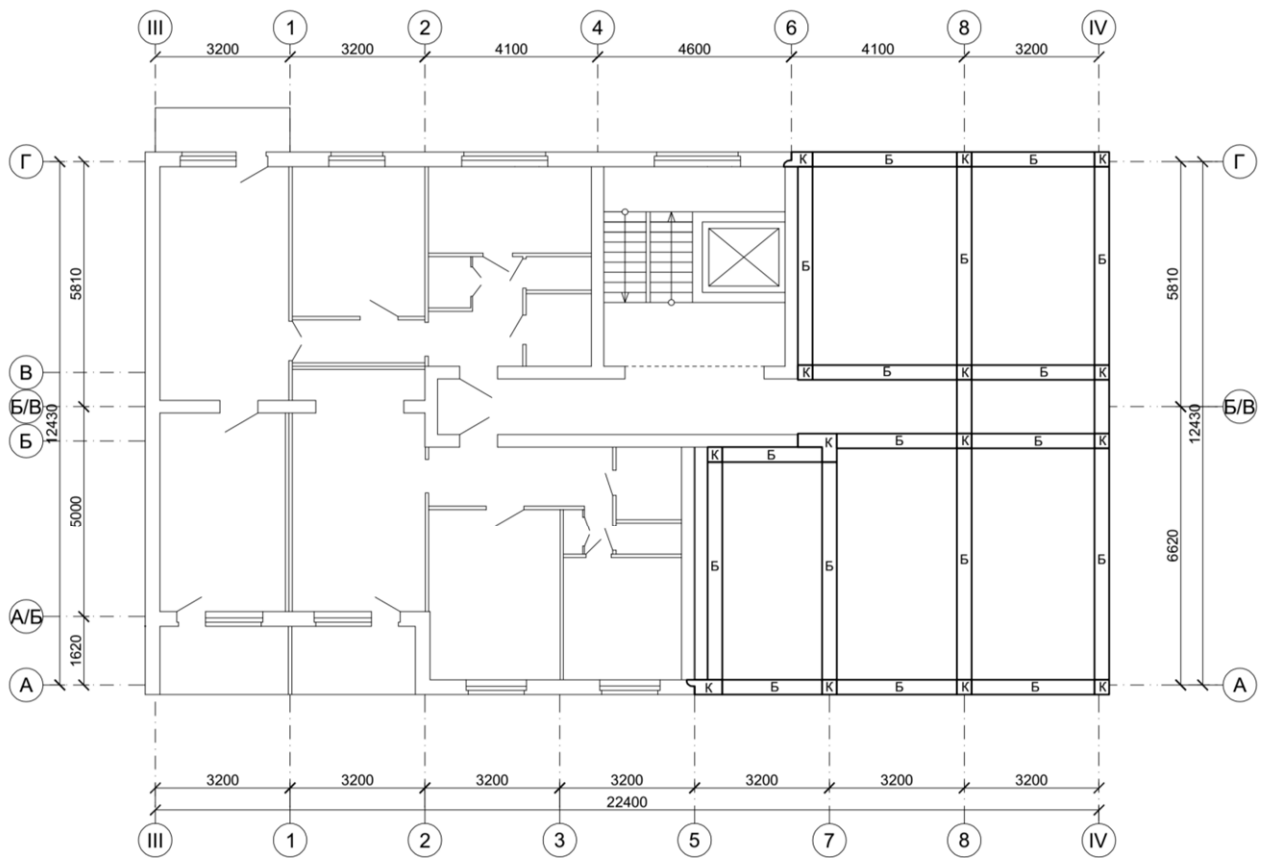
План типового поверху під'їзду № 1 будівлі об'єкта №2
